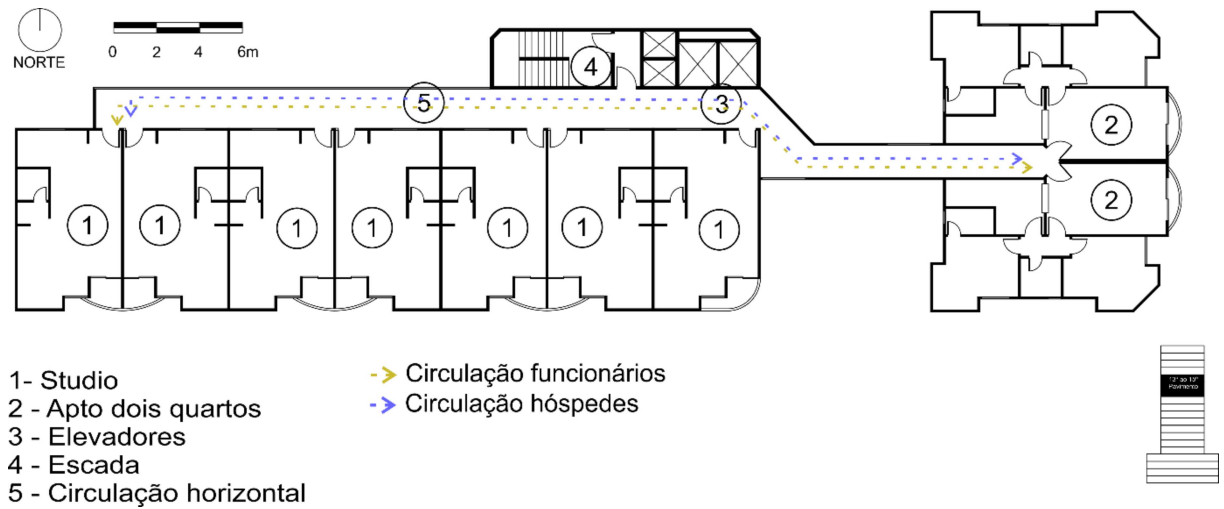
Planta baixa 5º ao 12º pavimento.
